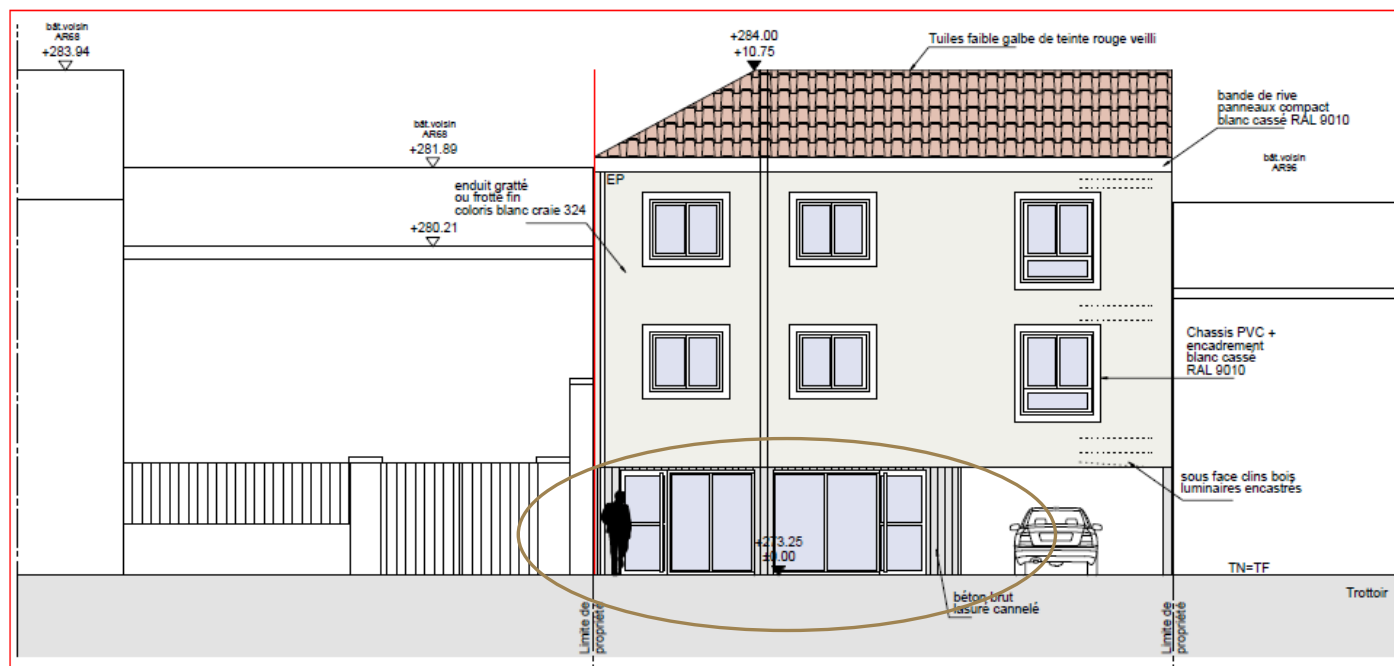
Façade Ouest de l'immeuble comprenant au rez-de-chaussée le local commercial
